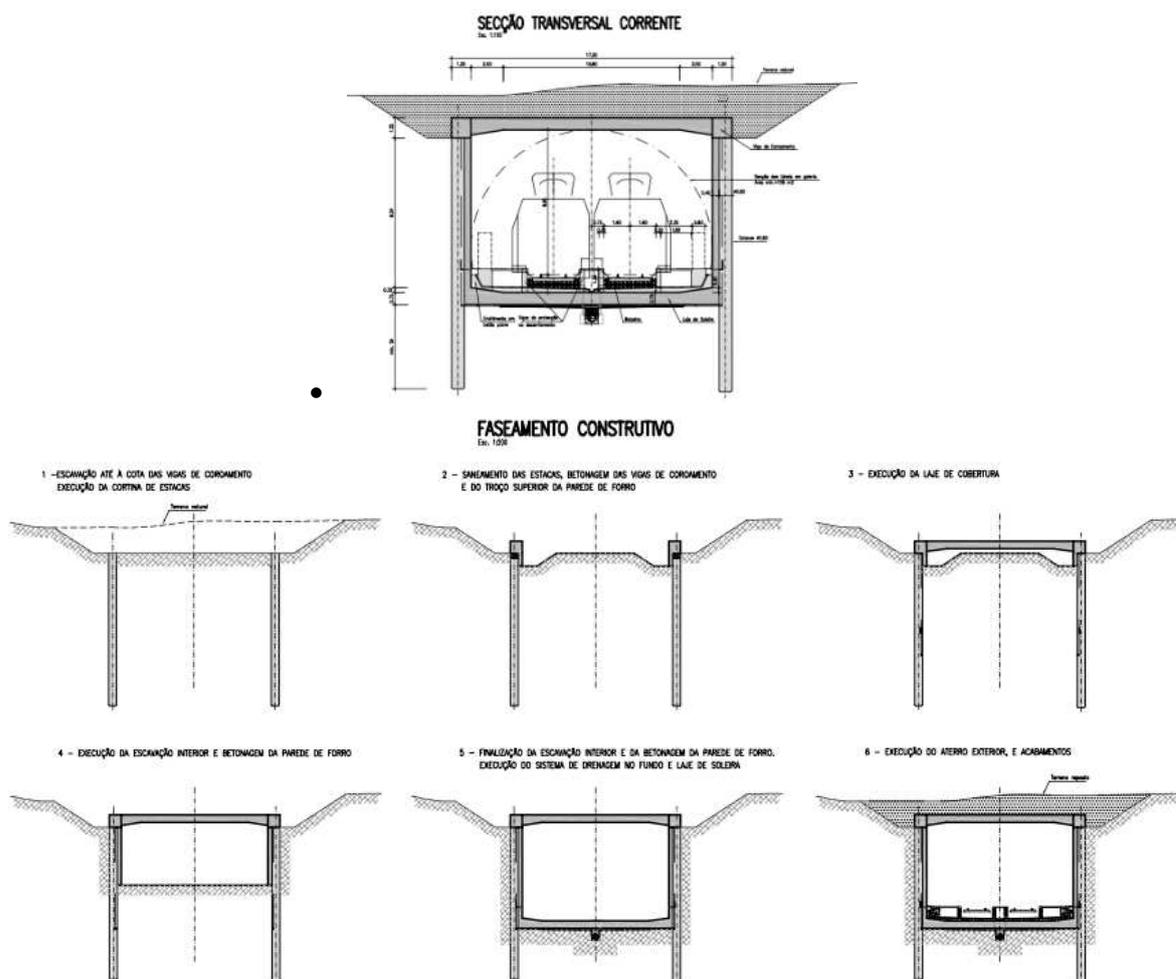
Ilustração de Processo Construtivo “Top-down”
